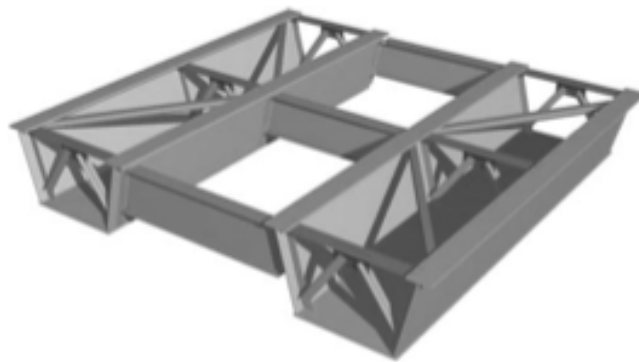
Vigas Tipo Cajón de Acero (Chen & Duan, 2014).
